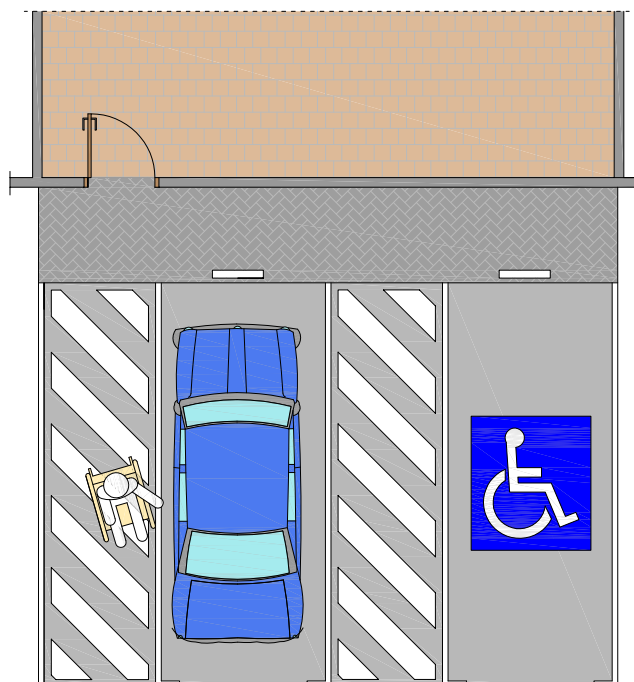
Aparcamiento reservado en batería junto a un edificio.
